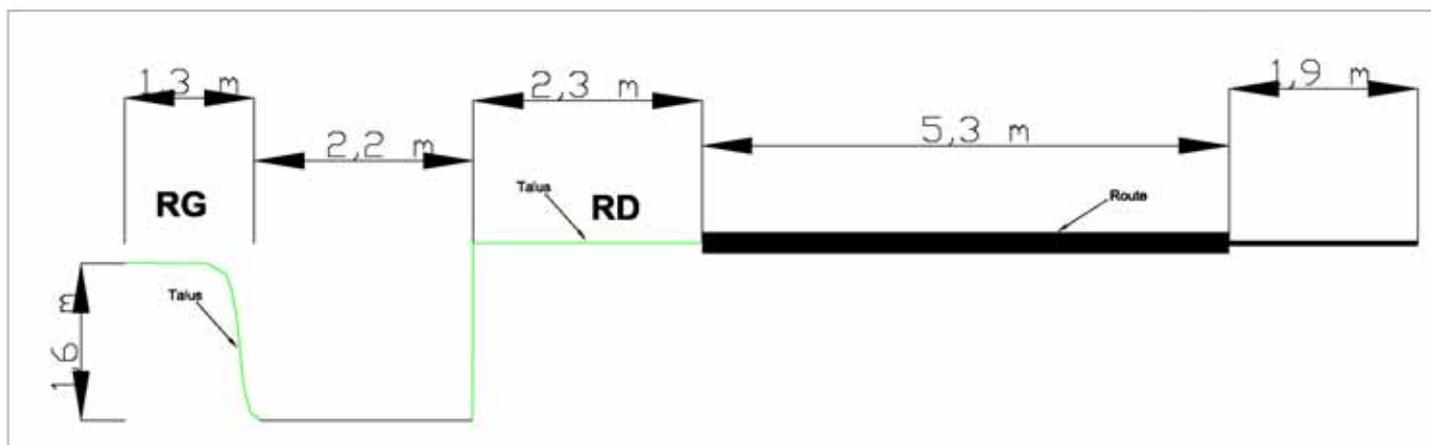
Schéma d'un profil transversal – Rive droite verticale -
